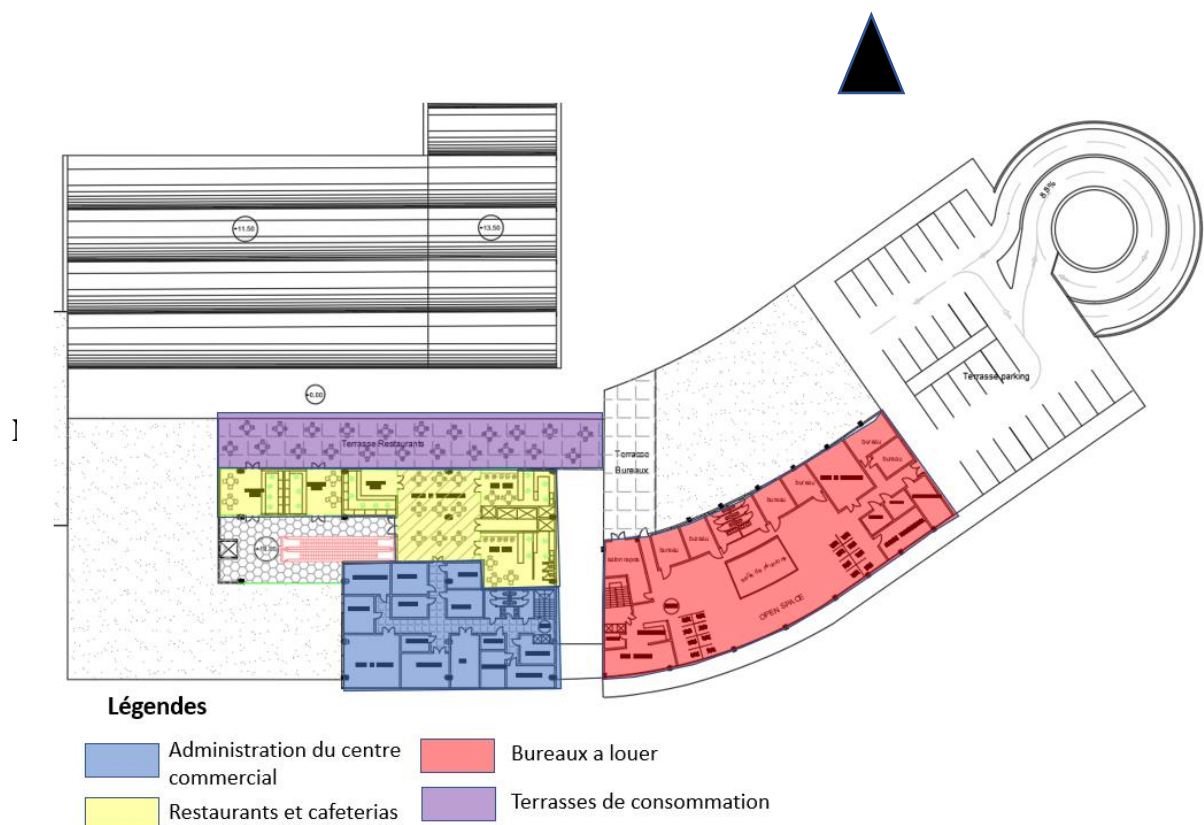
Plan du deuxième étage. (Source : auteur)
